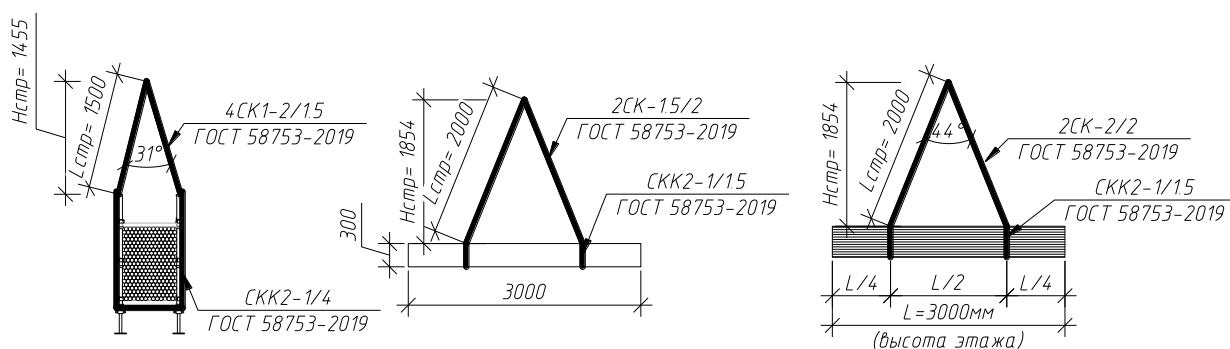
Определение длины стропов для элементов опалубки перекрытия, пачки профлиста и связки арматуры
